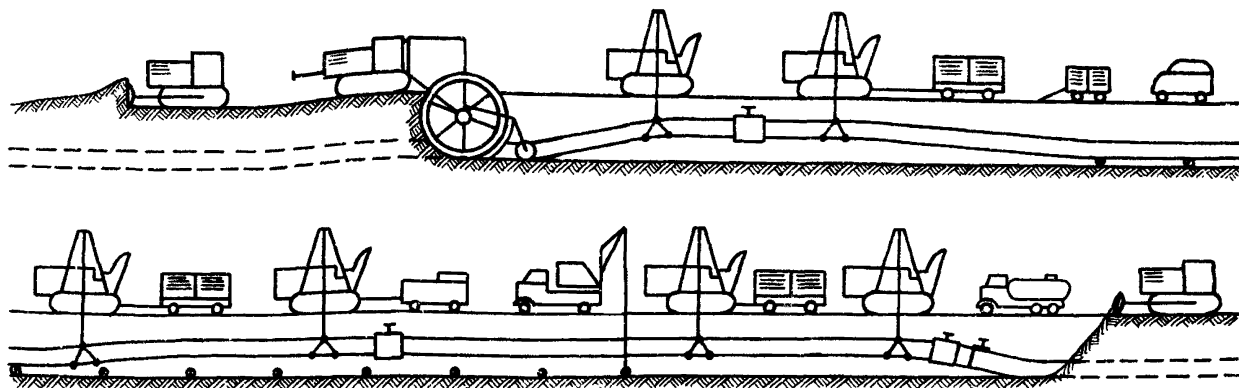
Схема капитального ремонта газопровода с подъемом и укладкой на лежки в траншее
